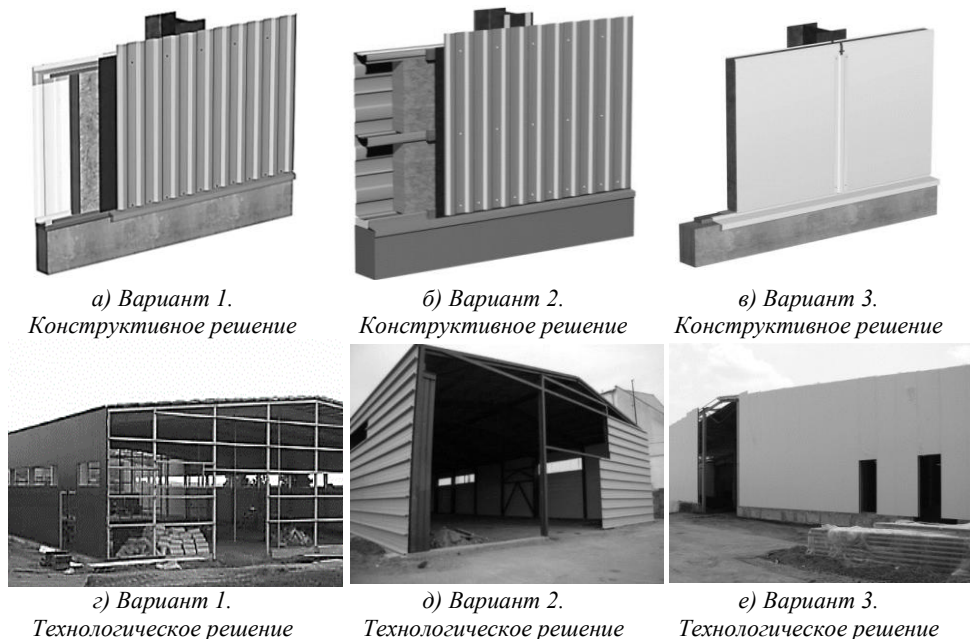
Варианты конструктивно-технологических решений наружных стен одноэтажного производственного здания каркасной схемы
